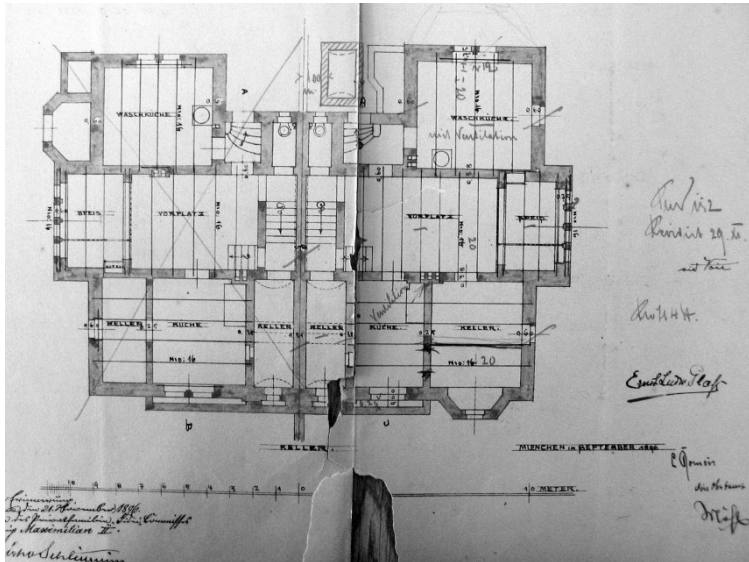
Doppelvilla Plaß/Kerschensteiner, Grundriß Kellergeschoß, Leonhard Romeis, 1896, Plan nach Westen ausgerichtet.
